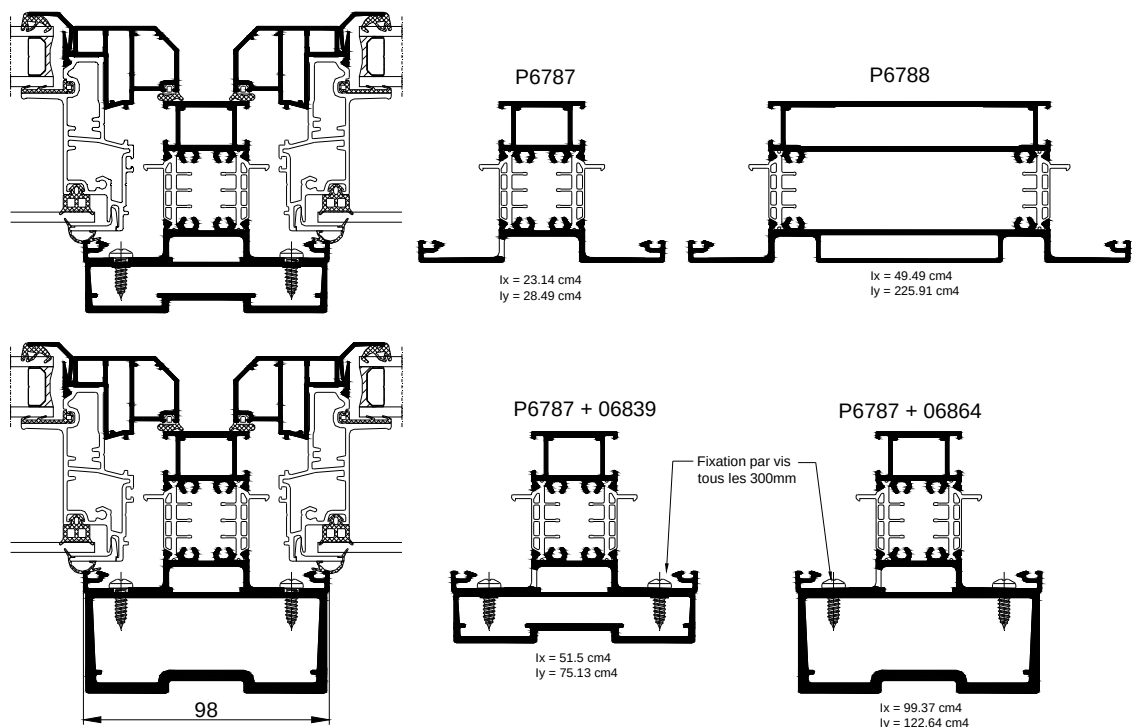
DETAIL D'ASSEMBLAGE DE L'OUVRANT
